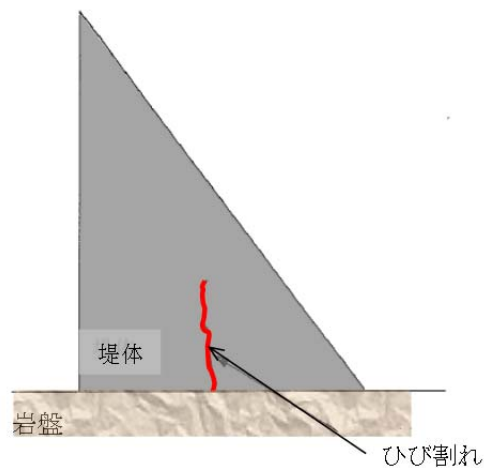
着岩コンクリートに発生したひび割れが上部リフトへ伝播する事例
